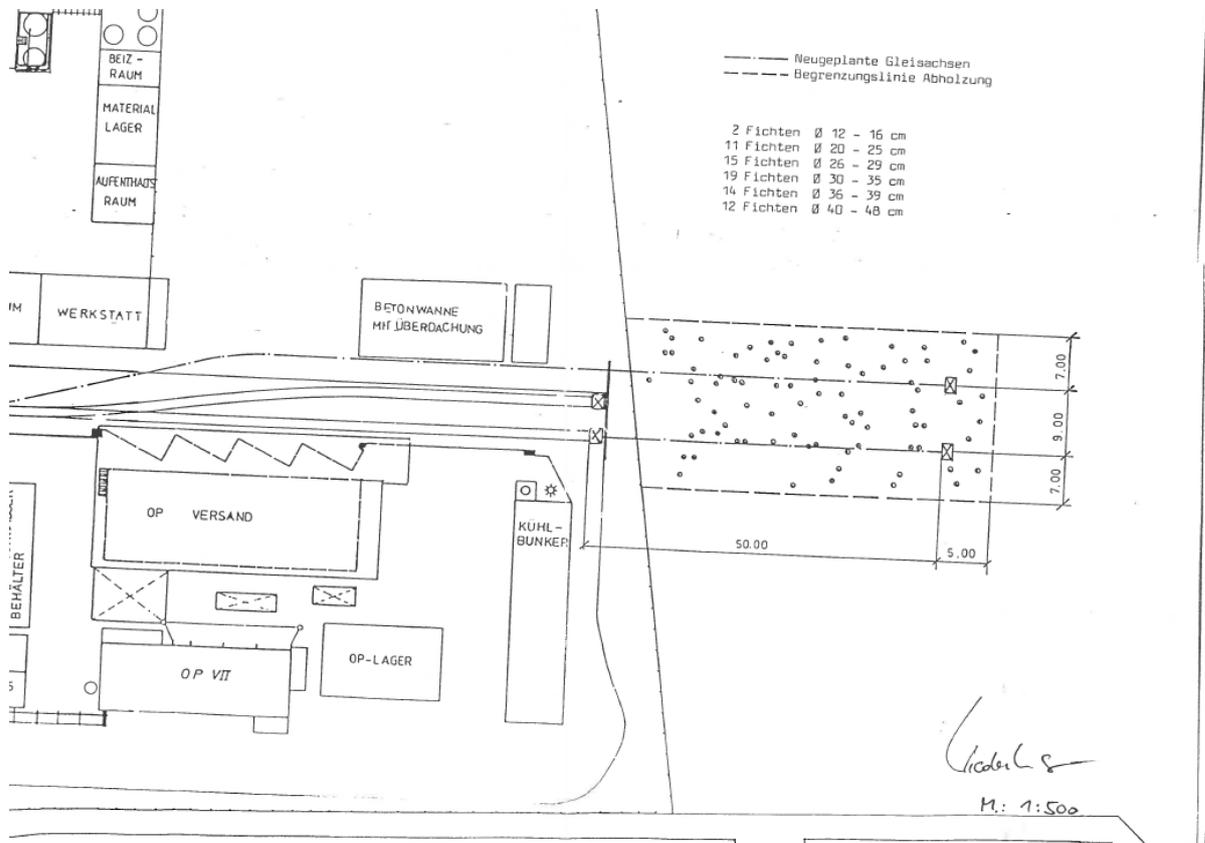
Ausschnitt des Bestandsplans über Waldbestand, Bauantragsnr. 302/88.
